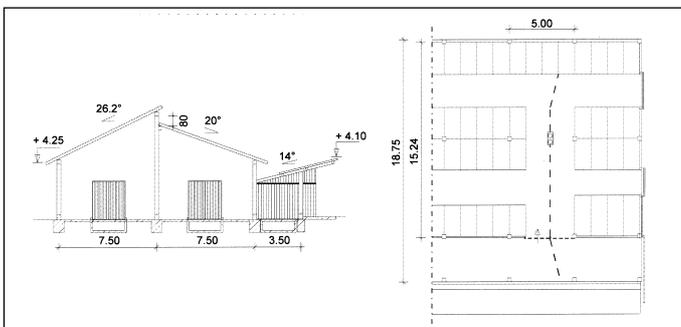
Schnitt und Grundriss des vierreihigen Liegeboxenlaufstalles mit seitlicher Außenfütterung
